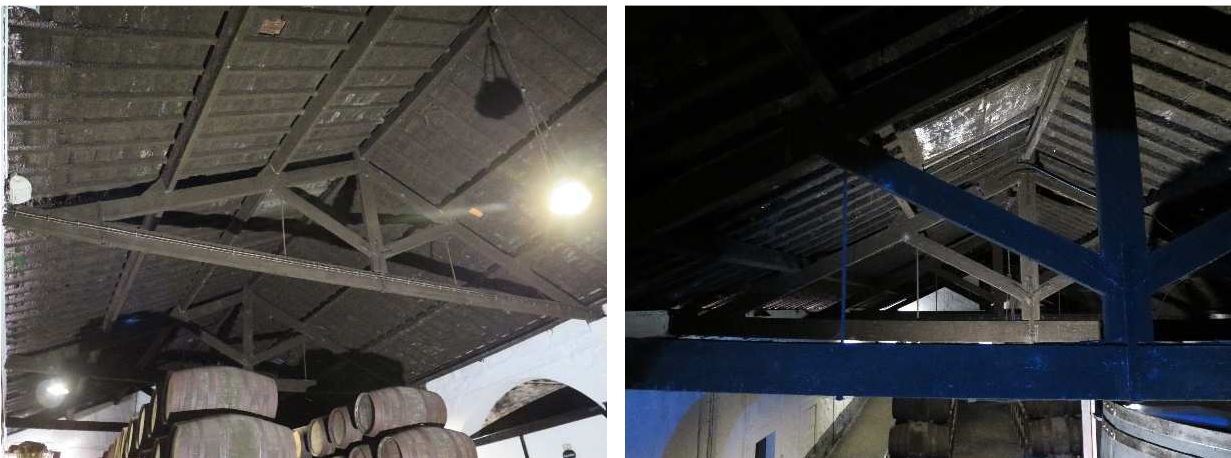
Cobertura em estudo: Levantamento fotográfico.
